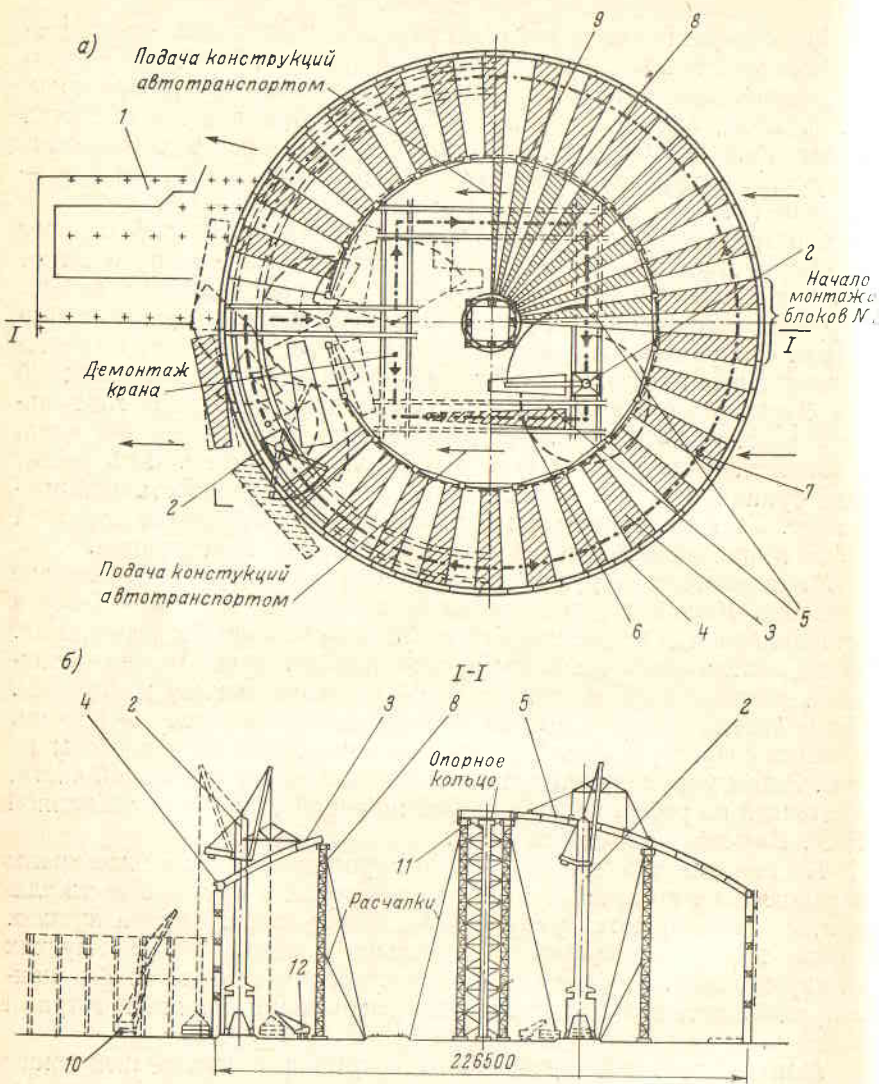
Схема монтажа конструкций купола над зданием высоковольтного испытательного центра
